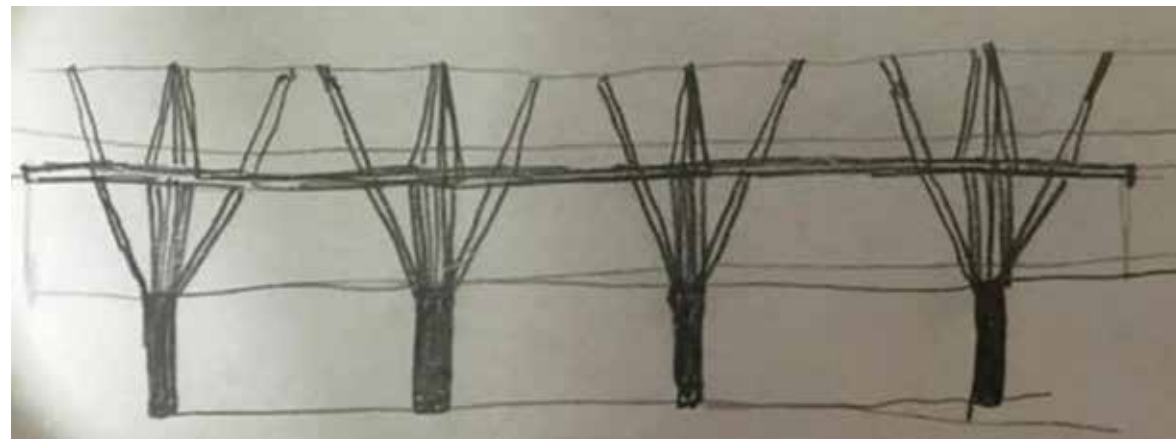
Boceto en corte de la cubierta de la propuesta 2
